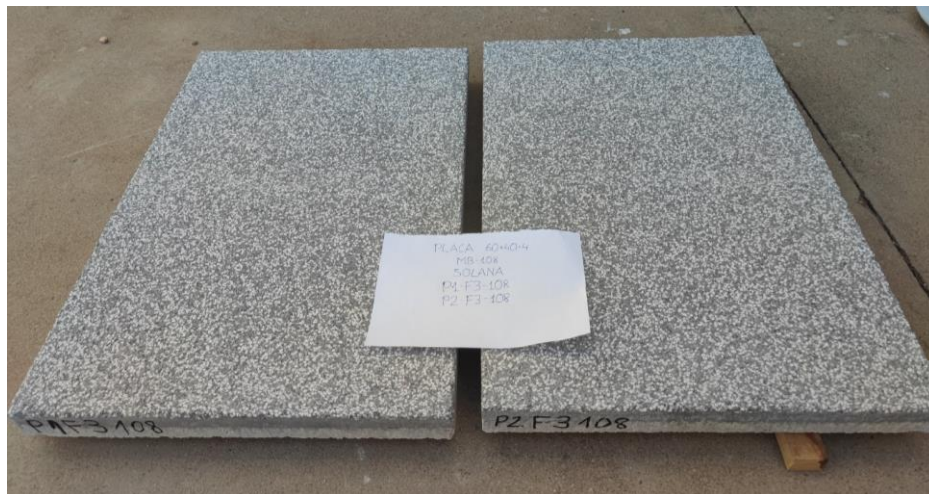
Fotografía pavimento MB108 Solana. Fuente: Elaboración propia
